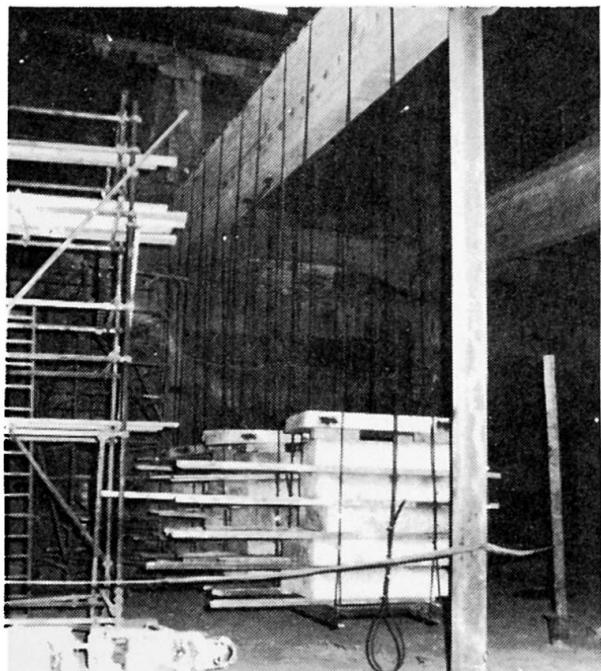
Prüfung eines Stahlbeton-Hallenbinders mit 24 m-Spannweite
